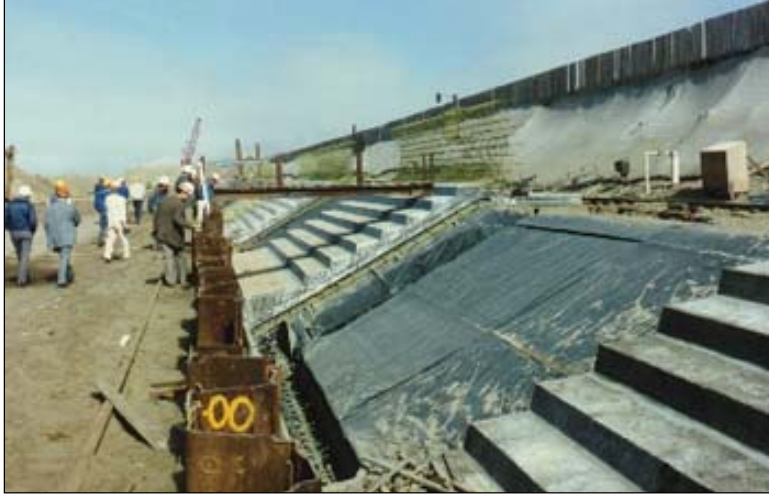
Beton bloklu kıyı duvarı [4]
